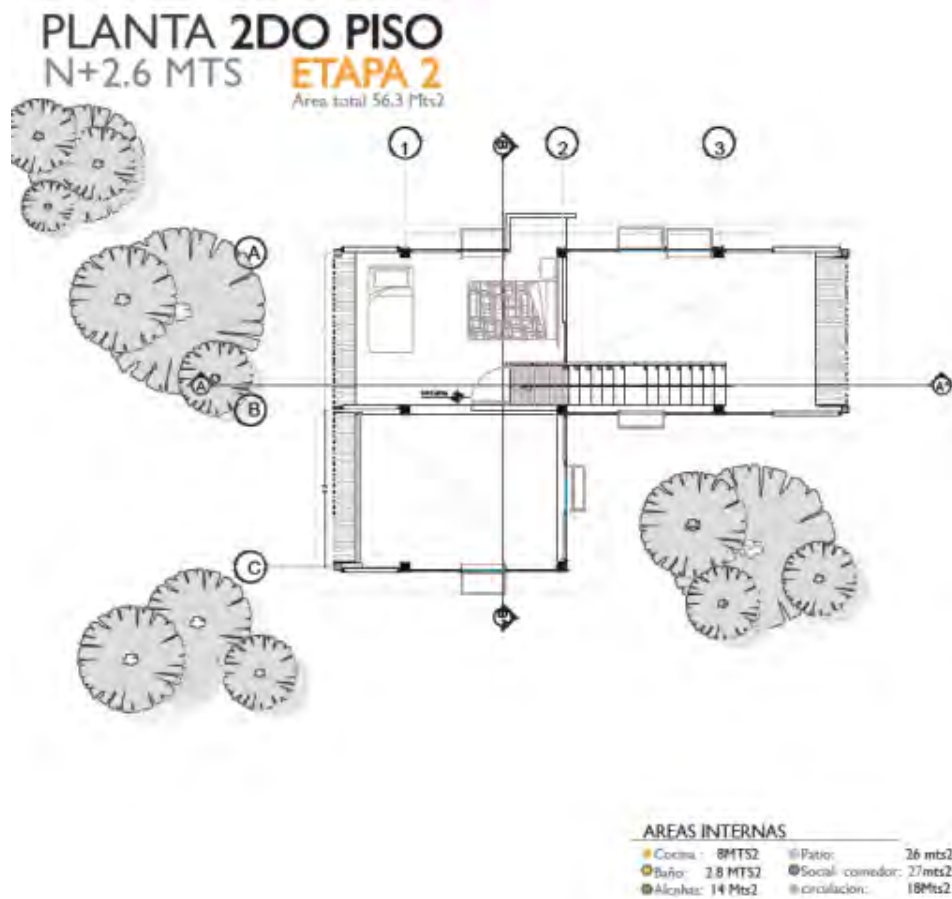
Planta 2 piso, Segunda etapa vivienda A1 Fuente: propia
